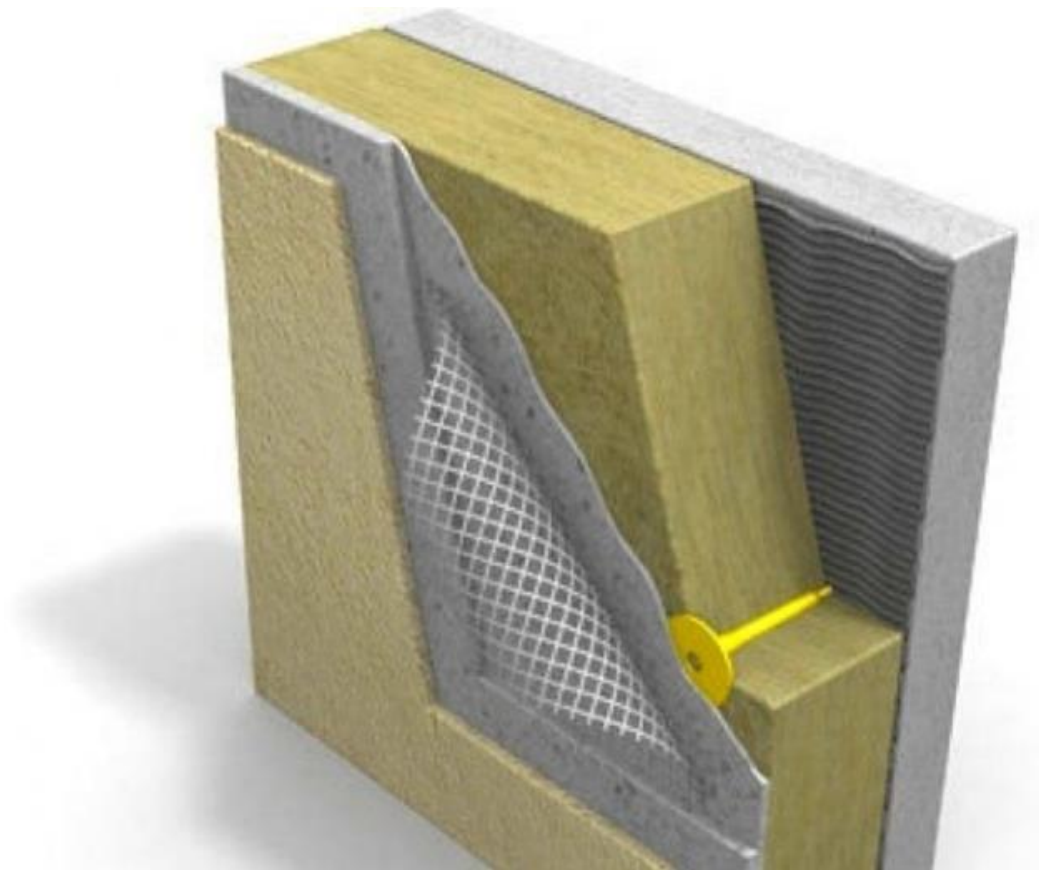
Конструкції систем невентильованого фасаду з утеплювачем з мінеральної вати
